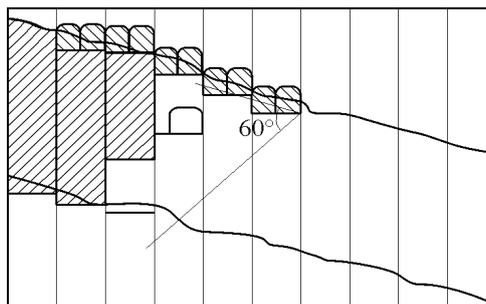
Сплошная слоевая система разработки с твердеющей закладкой и нисходящим порядком выемки слоев в защищенной зоне, образованной штреками перекрытия на руднике “Таймырский”
